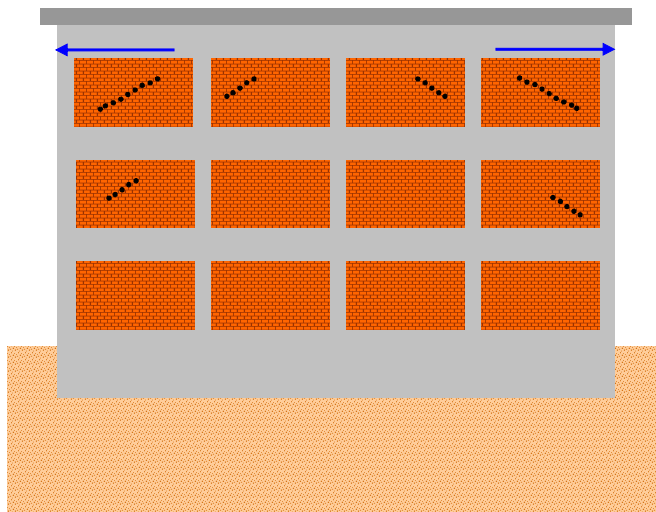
Fissuras de corte nas alvenarias, provocadas pela movimentação térmica da estrutura [61]
